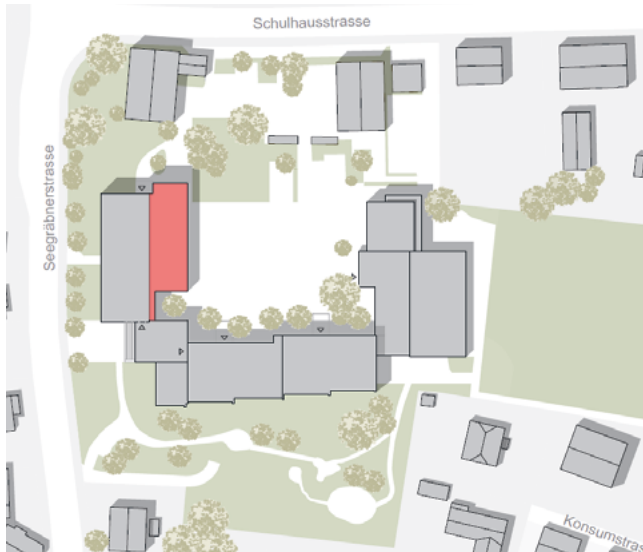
Situation mit Erweiterung (Planstand TU-Ausschreibung)
